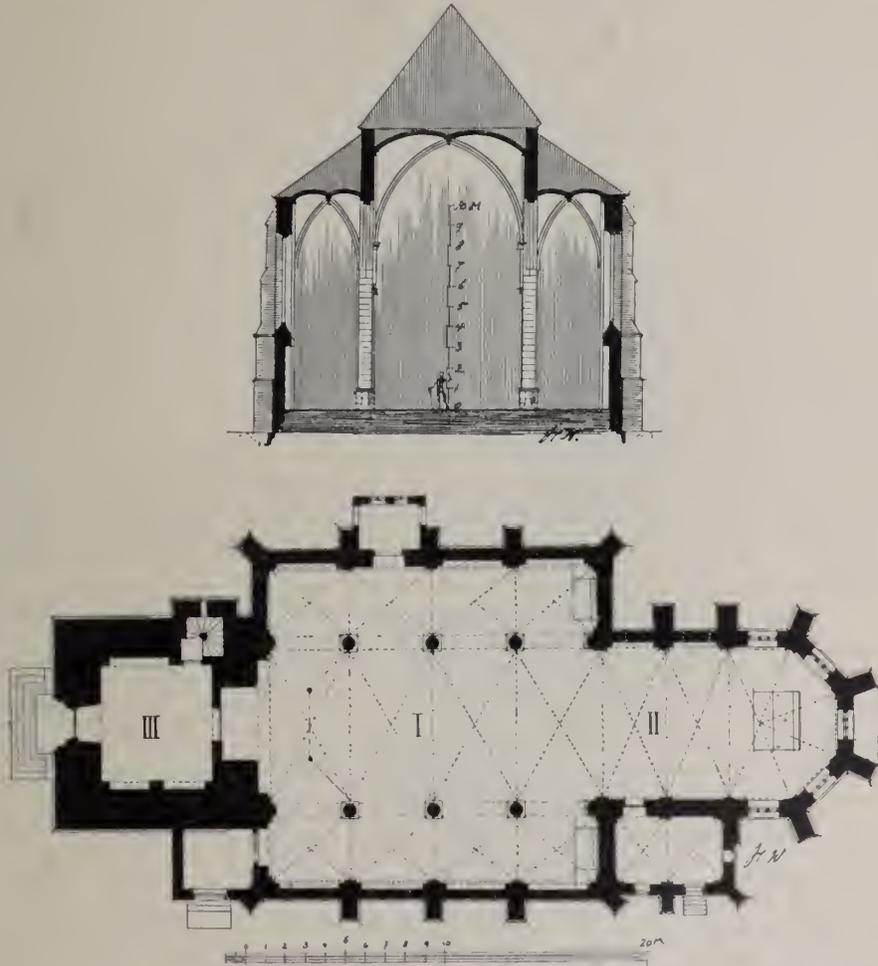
Dülken. Pfarrkirche. Grundriss und Querschnitt.
